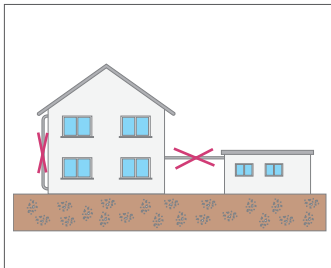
Наружная прокладка трубопроводов RAUTITAN flex, например, трубопроводов водоснабжения без соответствующих защитных мер недопустима
